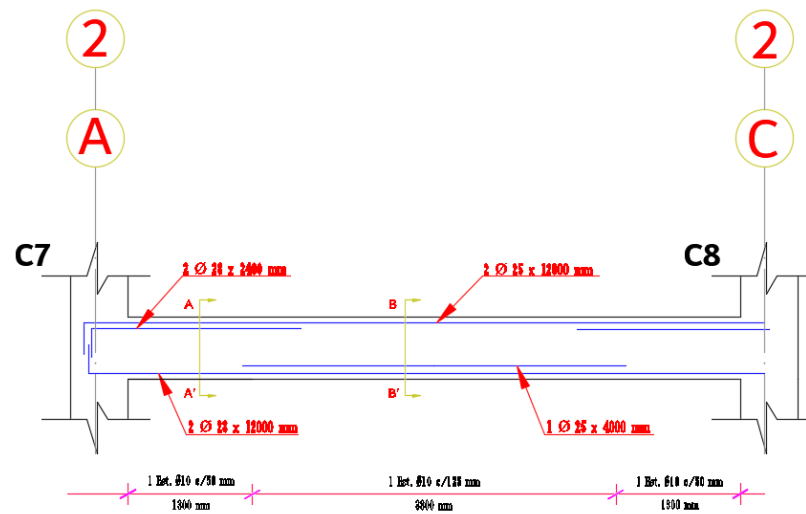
Detalle de viga principal eje "X" piso 1.
